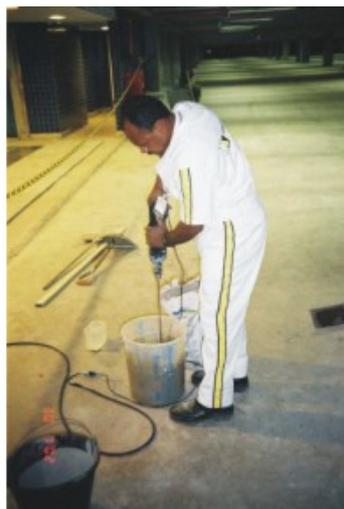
Misturador elétrico para homogeneização de argamassa colante.
